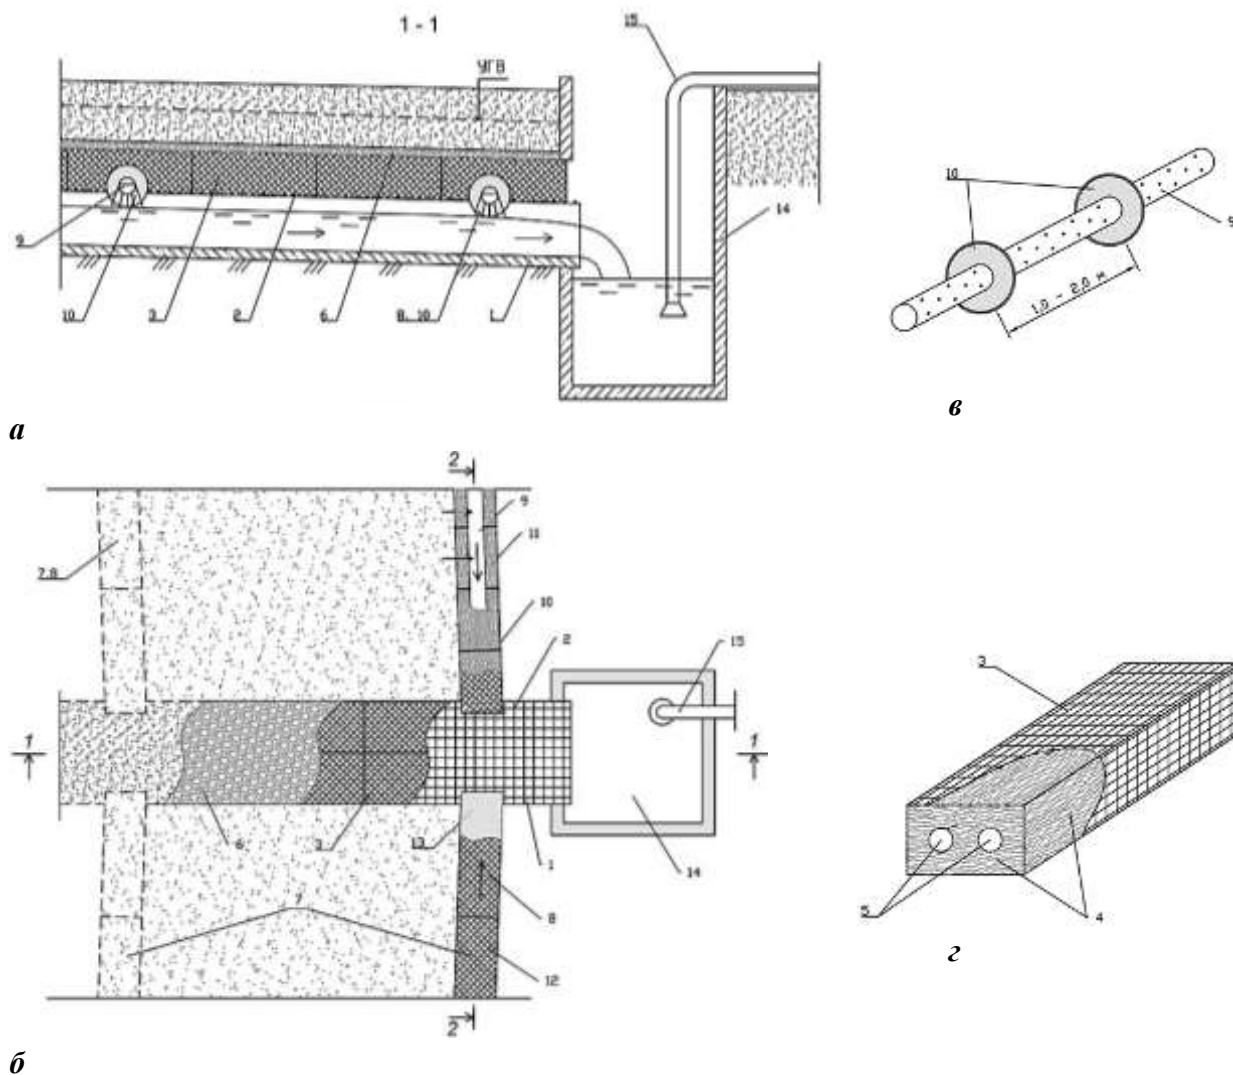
Горизонтальное водозаборное сооружение комбинированной конструкции: *а* – продольное сечение по оси водоприемного лотка горизонтального водозаборного сооружения; *б* – план основной части сооружения; *в* – дренажная труба с кольцами (ребрами) жесткости; *г* – габийонный тюфяк из геомата и перфорированных труб.
